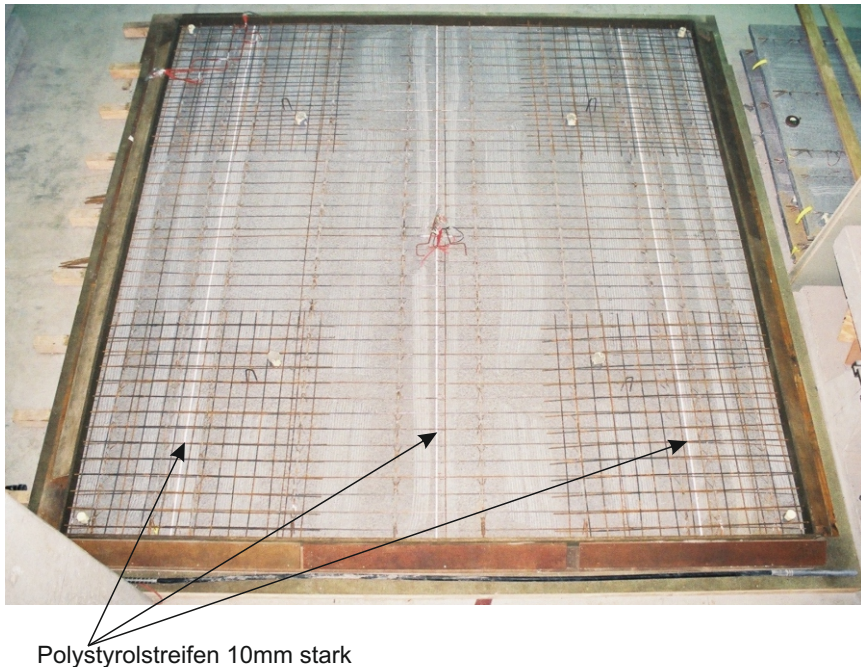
Draufsicht Platte 2, Schalung und eingebaute Bewehrung der Ortbetongergänzung
